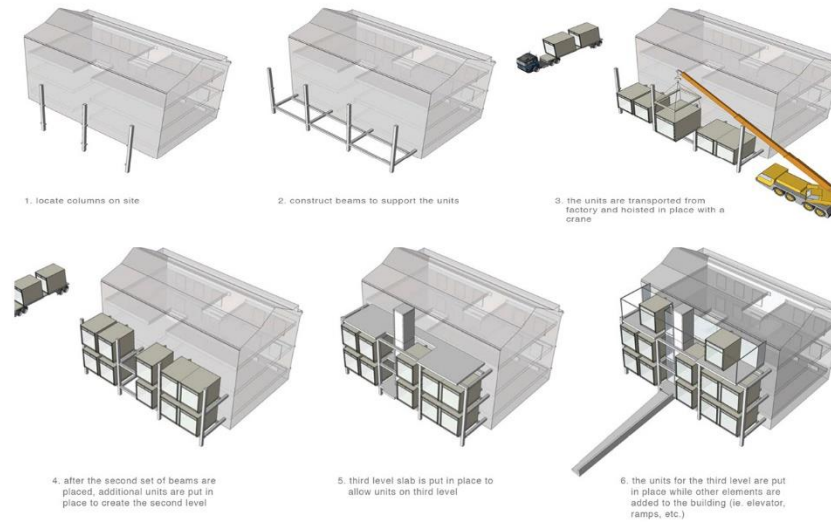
Proceso de montaje de la estructura y los módulos prefabricados
